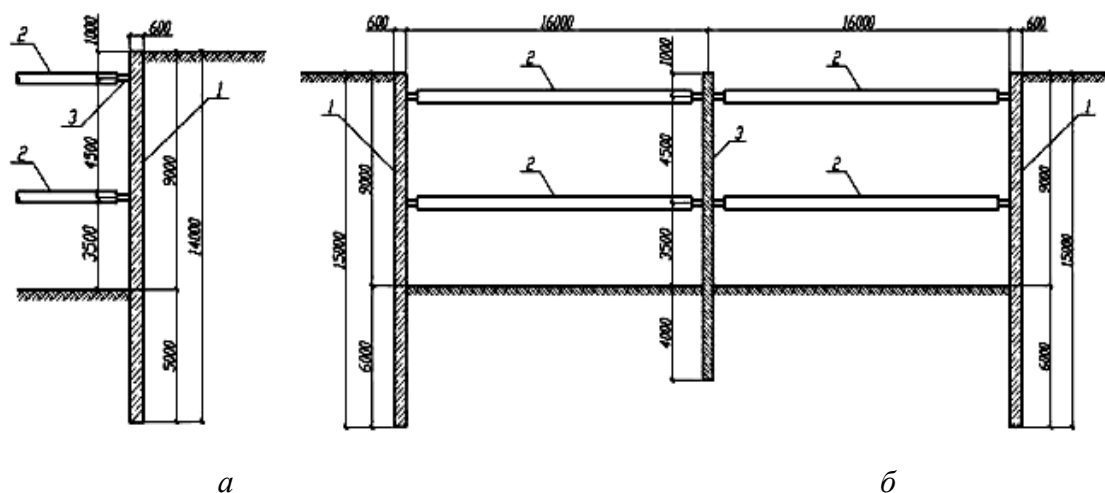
Распорное крепление (а); распорное крепление с промежуточными сваями (б):
